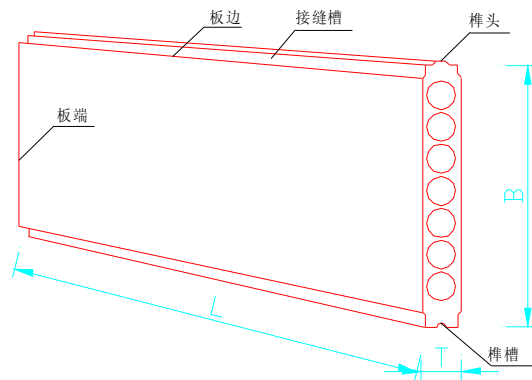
工业灰渣混凝土空心隔墙条板各部位名称及外形示意图
